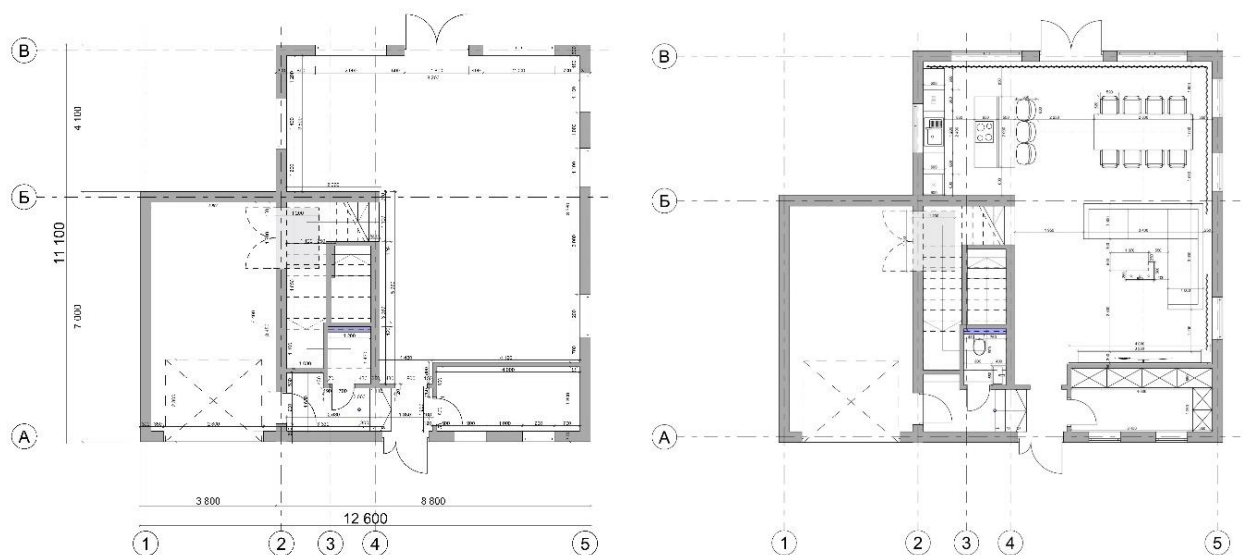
Планувальні схеми першого поверху обраного будинку: а) схема планування стін з розмірами, б) схема розташування меблів з розмірами
